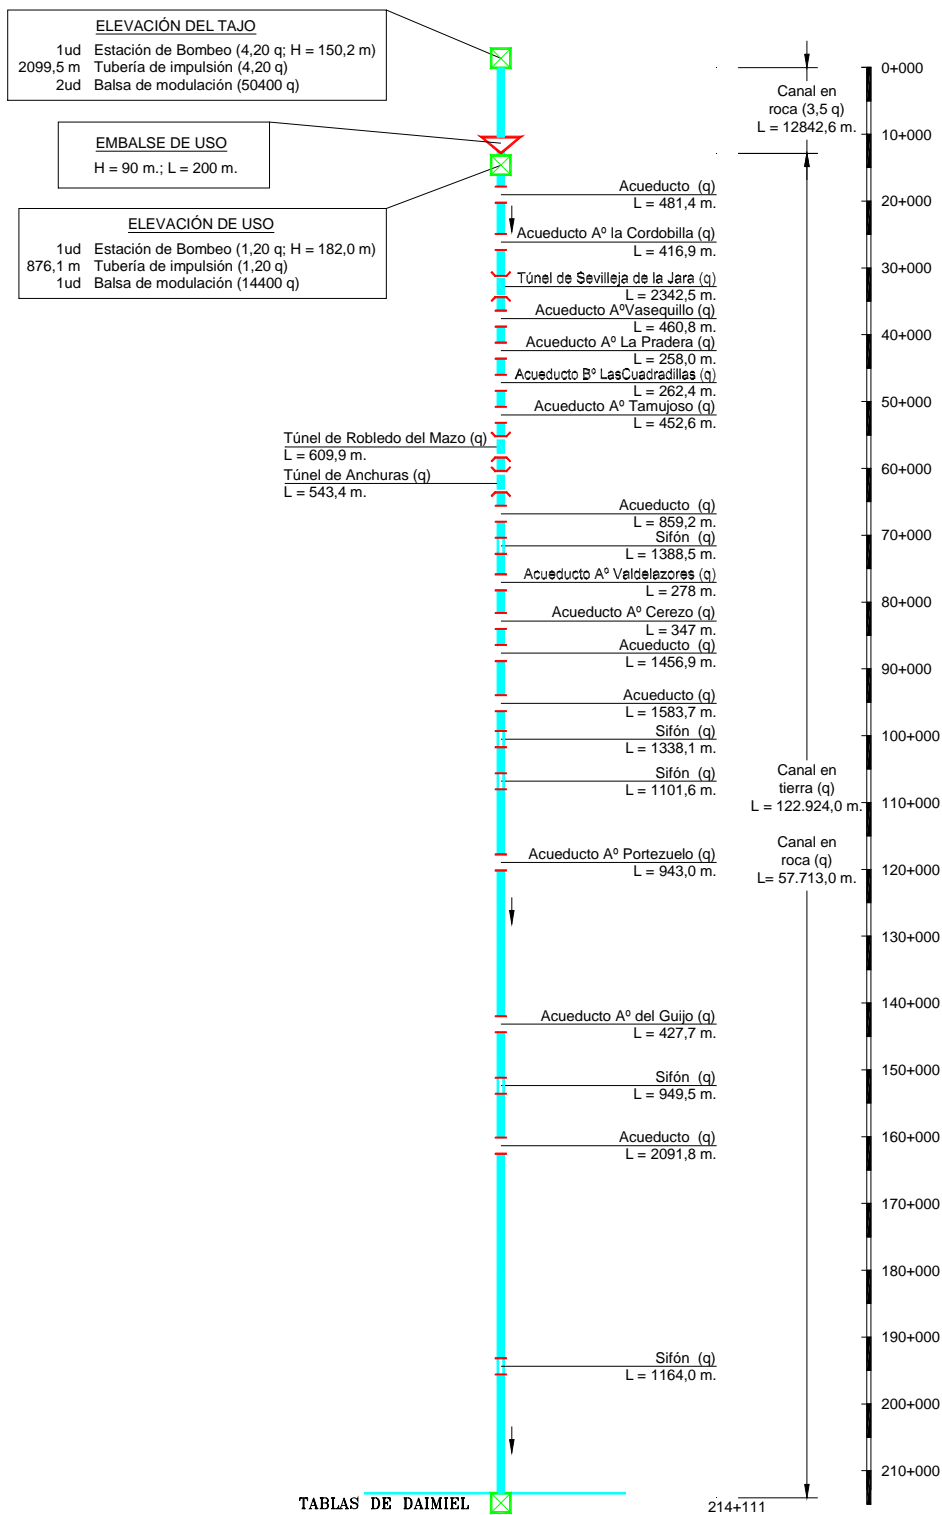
Conducción Aldeanueva-Daimiel. Esquema en planta
